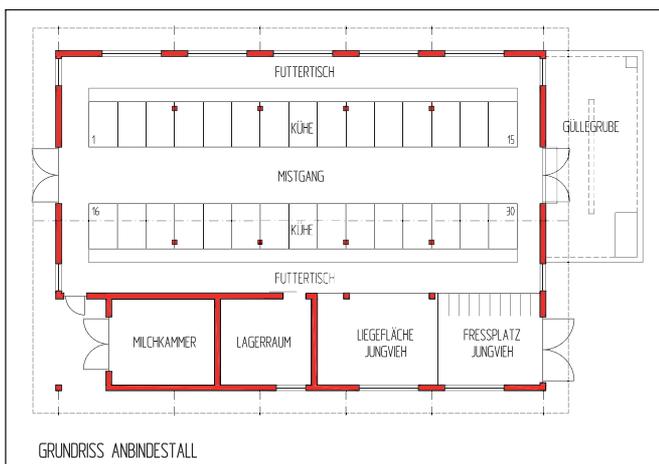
Grundriss Anbindestall (© Andreas Leichter)
